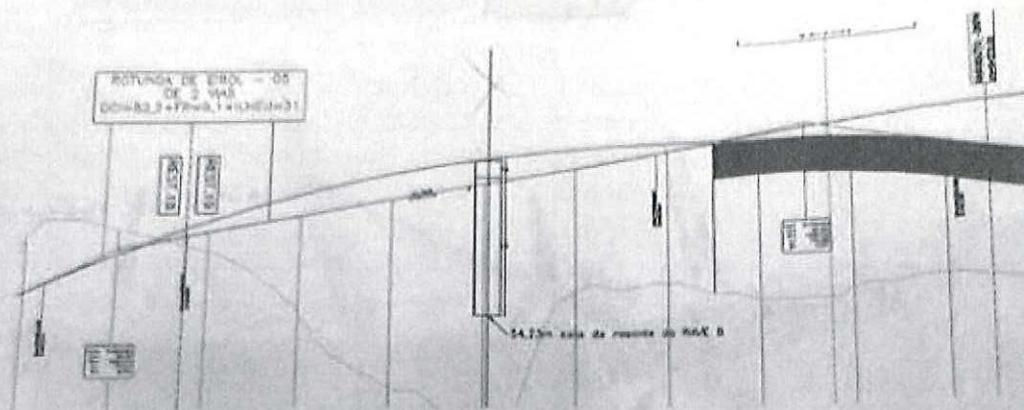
SOLUÇÃO B DO TRAÇADO DA RAVE – PERFIL LONGITUDINAL
